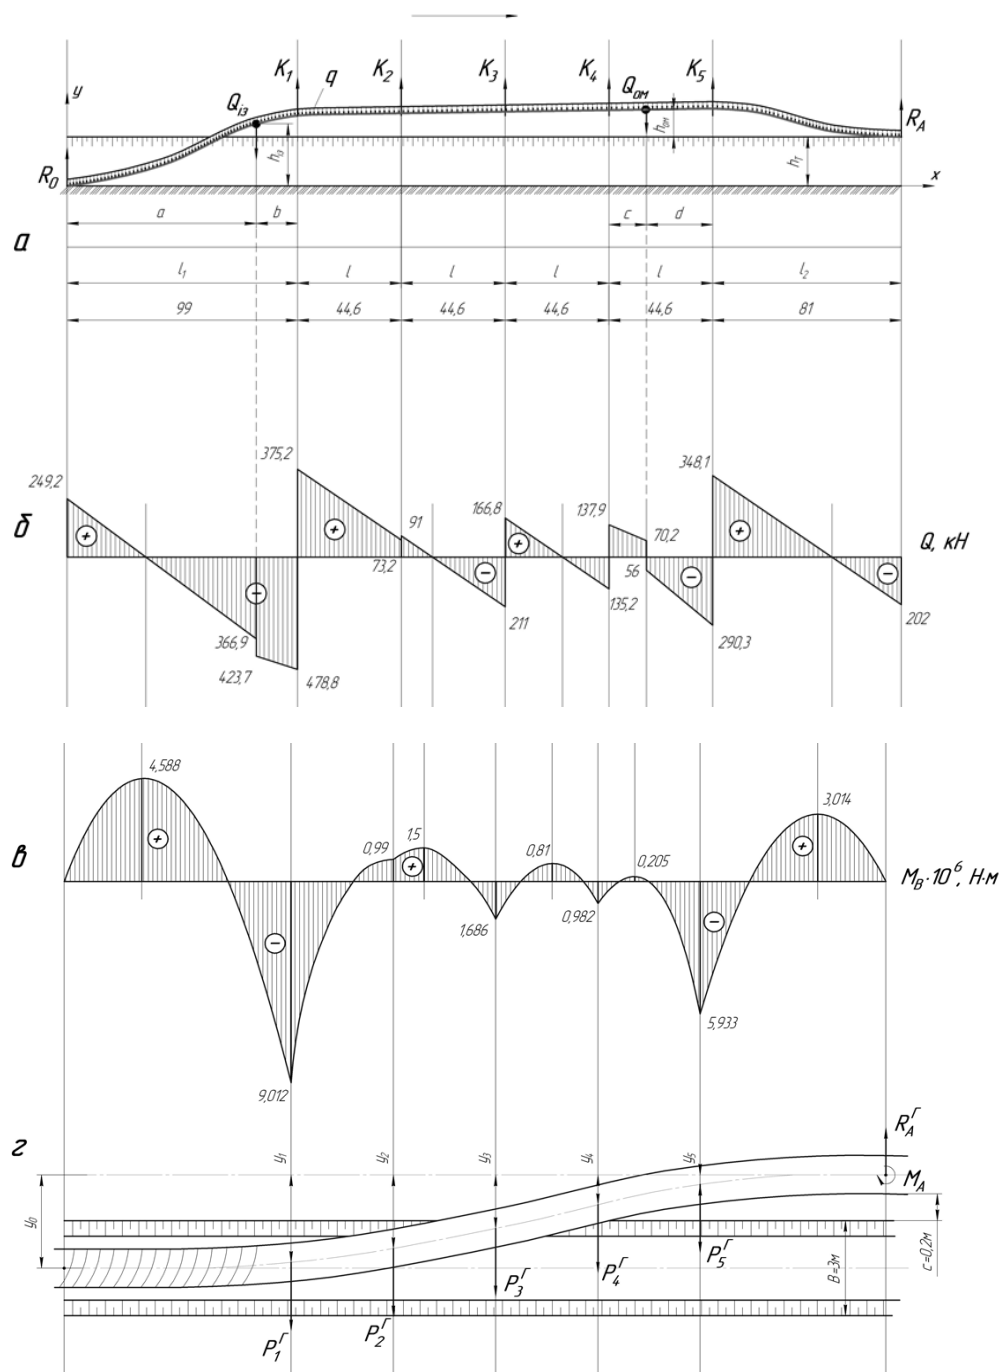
Розрахункові схеми та епюри від навантажень при проведенні ізоляційно-укладальних робіт сумішним методом: а – технологічна схема ІУР сумішним методом; б – епюра поперечних сил (вертикальна площина); в – епюра згинаючих моментів (вертикальна площина); г – схема пружнозигнутої осі трубопроводу (горизонтальна площина)
